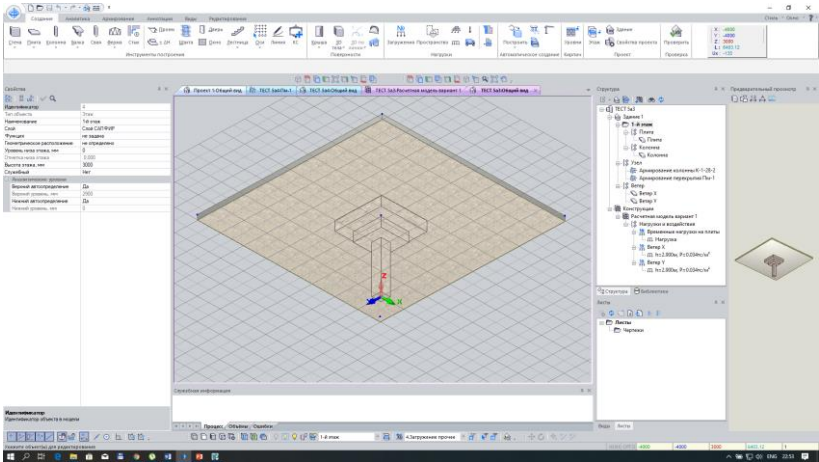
BIM-модель фрагменту залізобетонного перекриття, опертого на колону із капітелями
